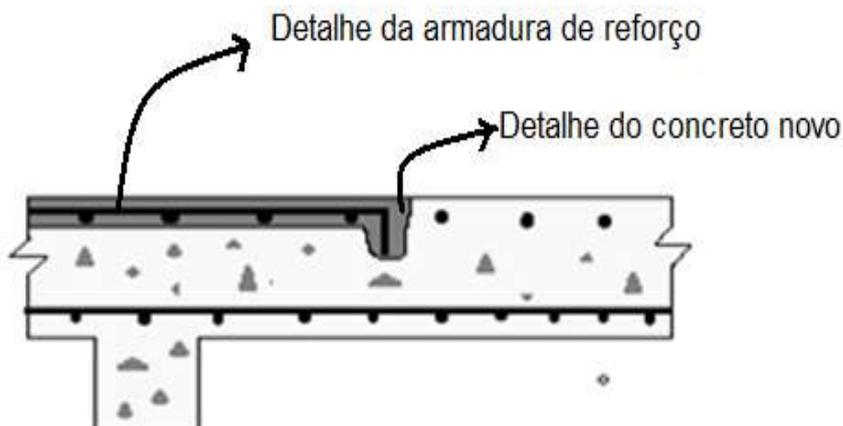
Corte AA escavação para Introdução da armadura de reforço
